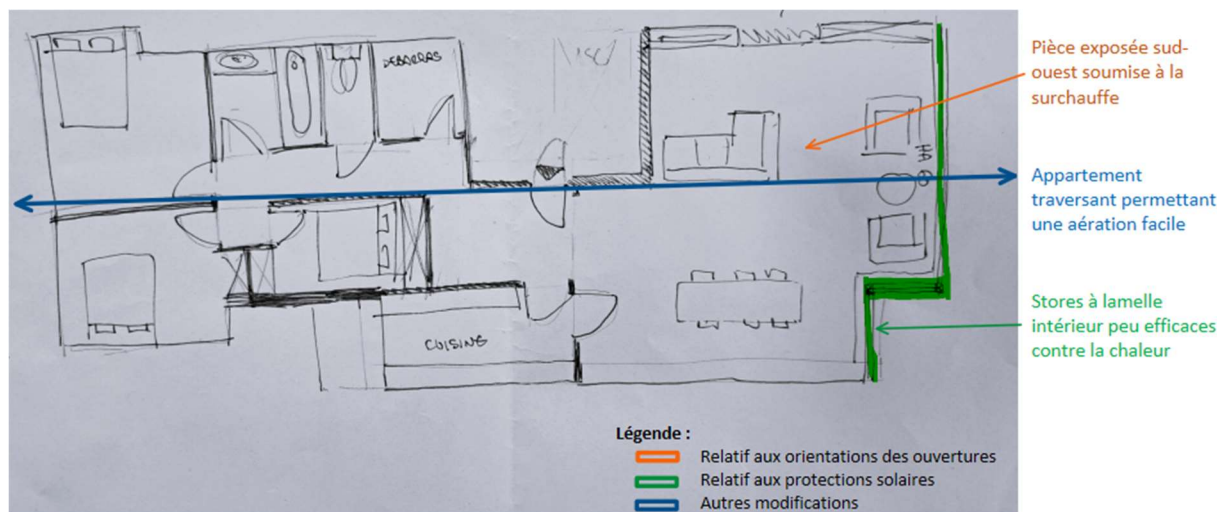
Architecte 3 : Logement 1 : Surchauffe
